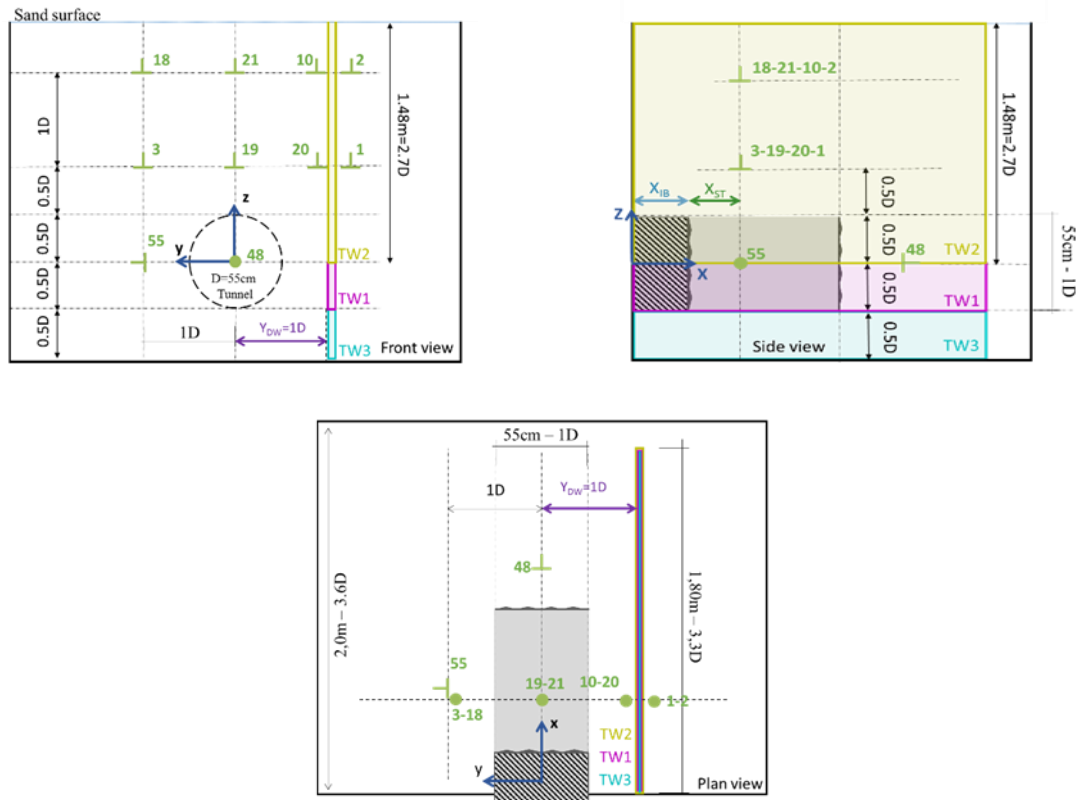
Positionnement des capteurs de déplacements internes lors des essais TW1, TW2 et TW3. (Vue en coupe transverse, vue coupe longitudinale, vue en plan)
